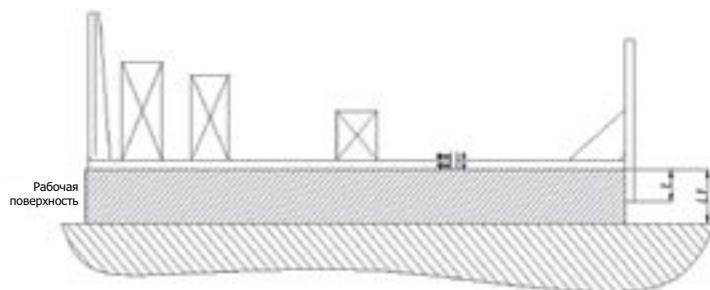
Пример монтажа рамной конструкции на рабочей поверхности. (Внешний вид может отличаться)
